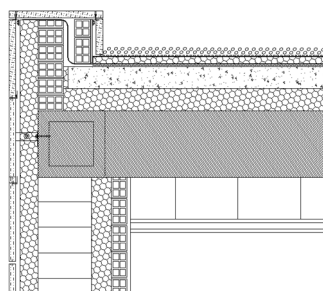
Sección fachada de la vivienda objeto. Fuente: Elaboración Propia.
